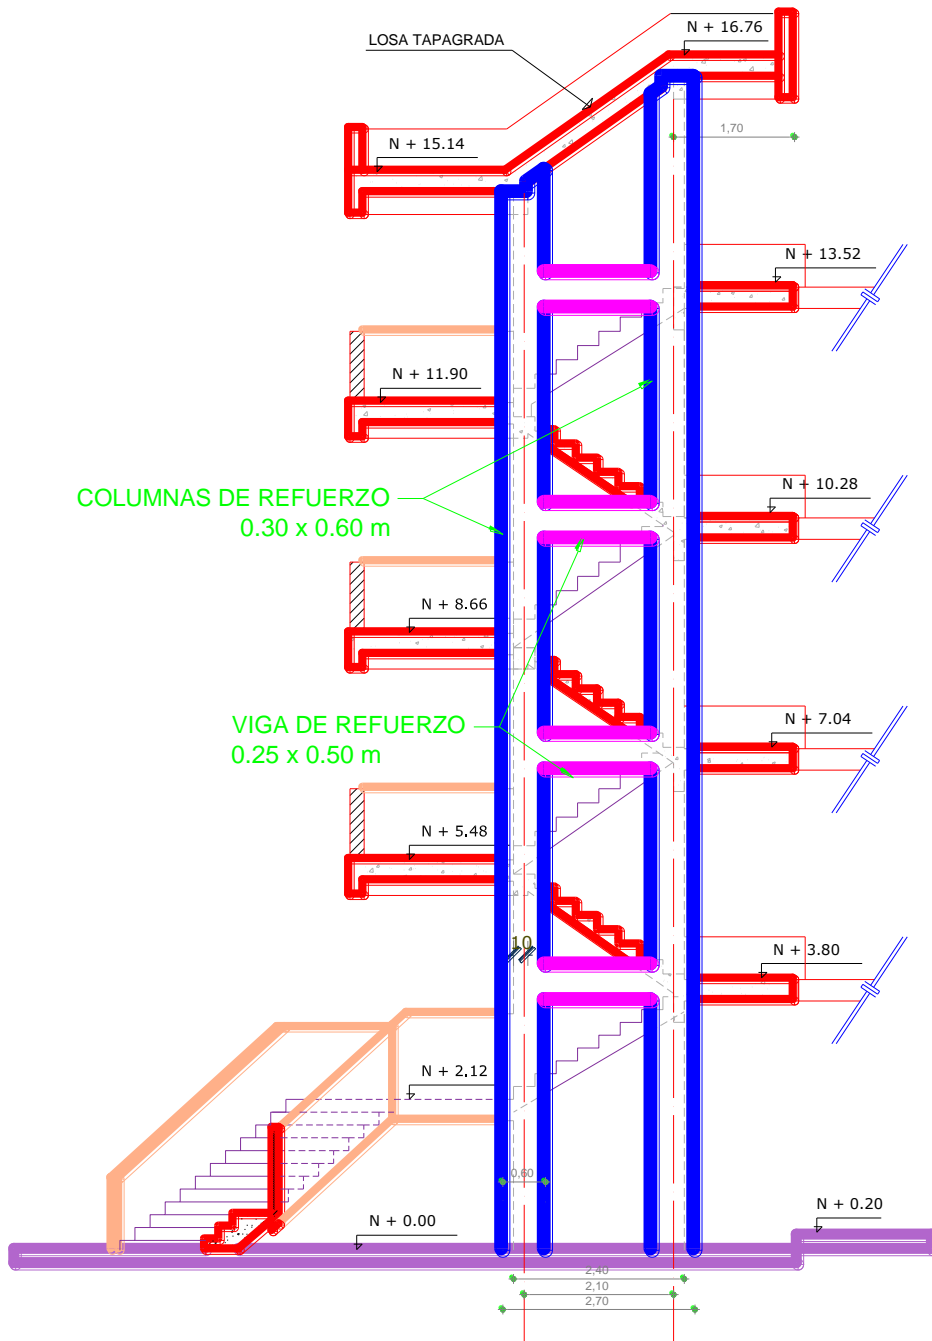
Vista de la grada existente y de las columnas y vigas de refuerzo.
